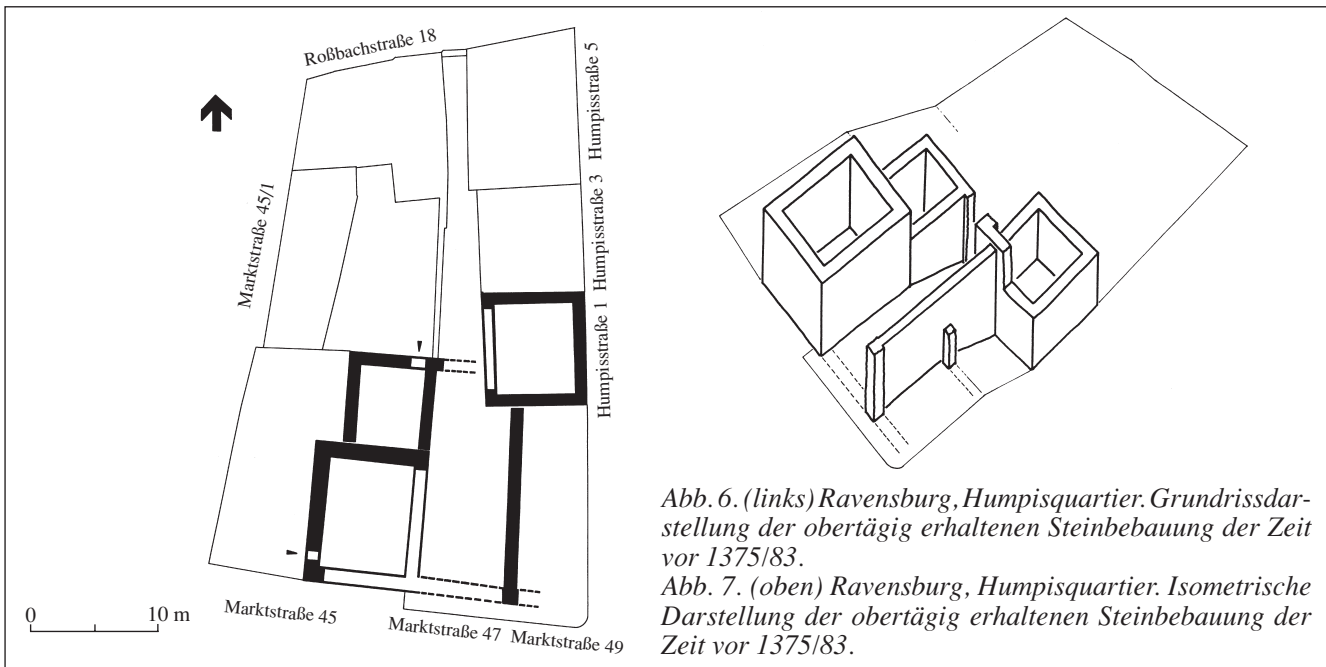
(links) Ravensburg, Humpisquartier. Grundrissdarstellung der obertägig erhaltenen Steinbebauung der Zeit vor 1375/83.
